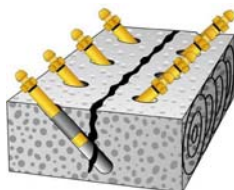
Bicos Injetores de Perfuração Metálicos
